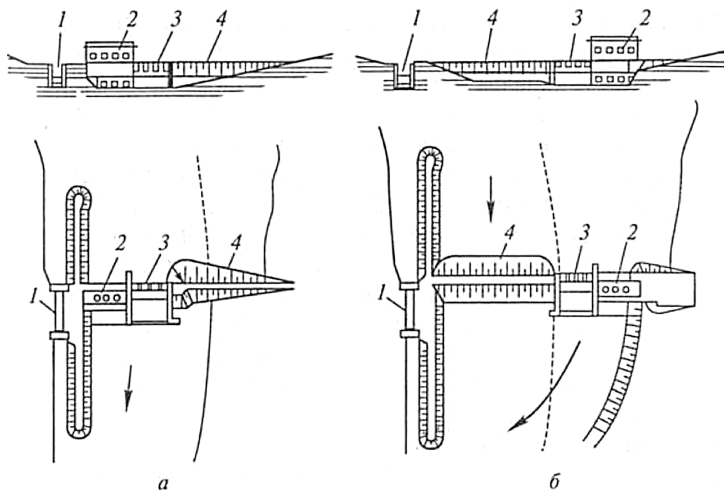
Компоновка ГЭС в низконапорных гидроузлах: а – русловая; б – пойменная; 1 – судопропускной шлюз; 2 – здание станции; 3 – водоливная плотина; 4 – глухая плотина
